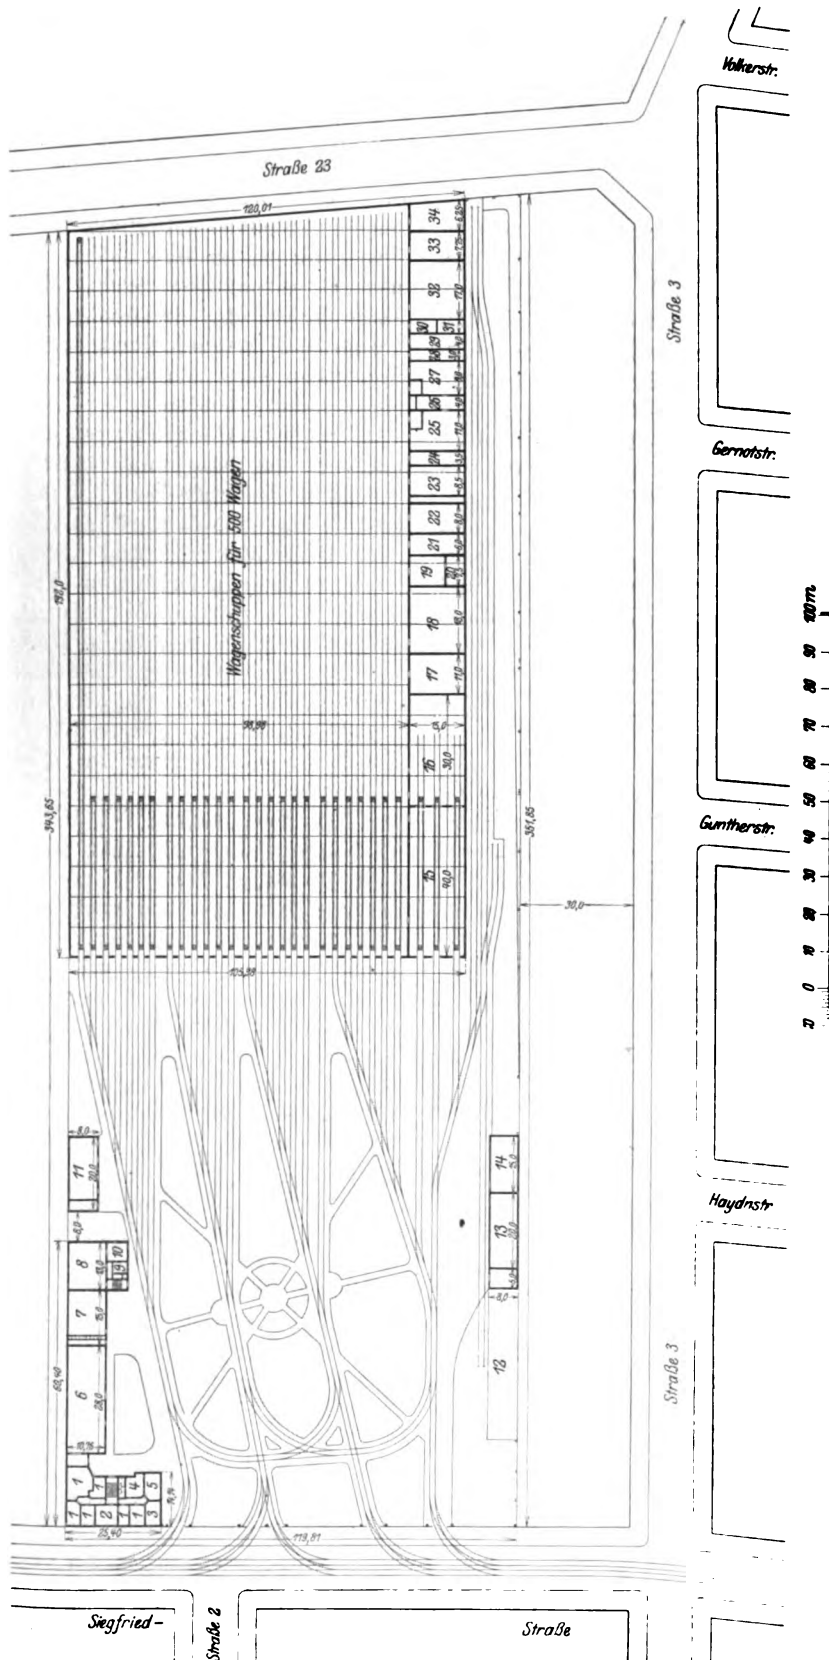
Lageplan des Straßenbahnhofs in Berlin-Lichtenberg.
